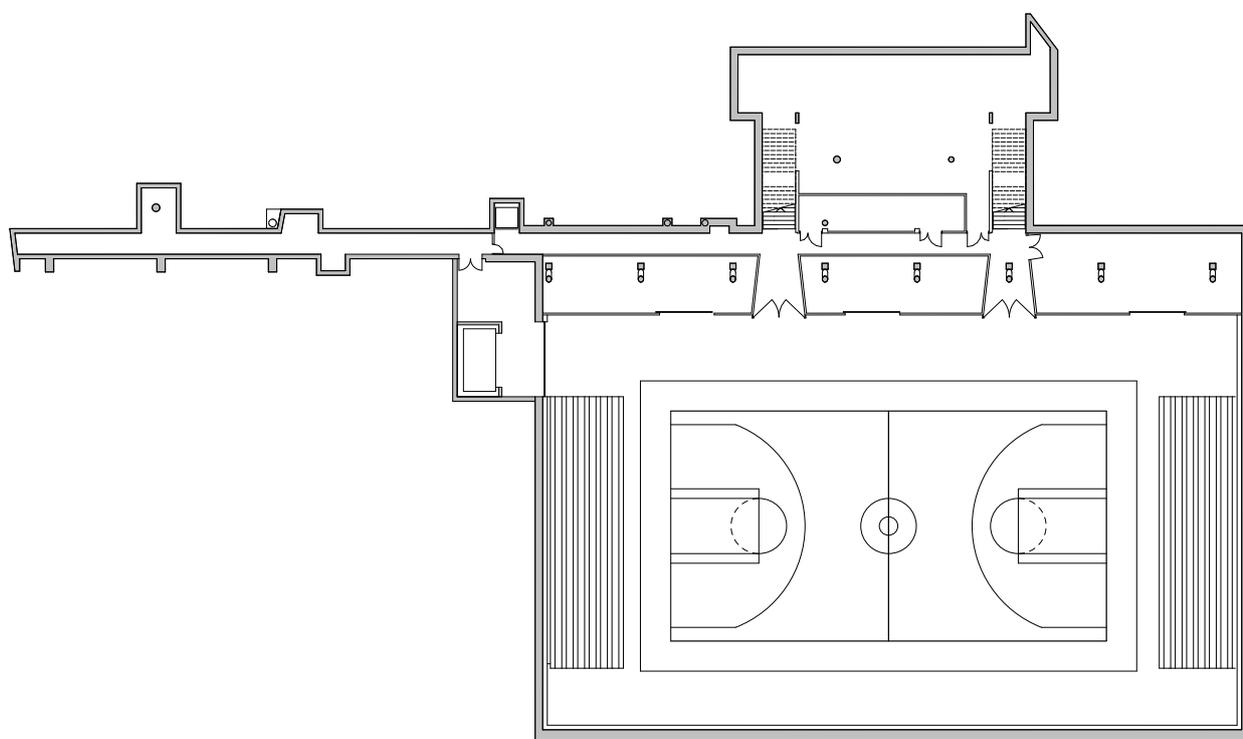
Grundriss 2.UG - Basketballturnier
